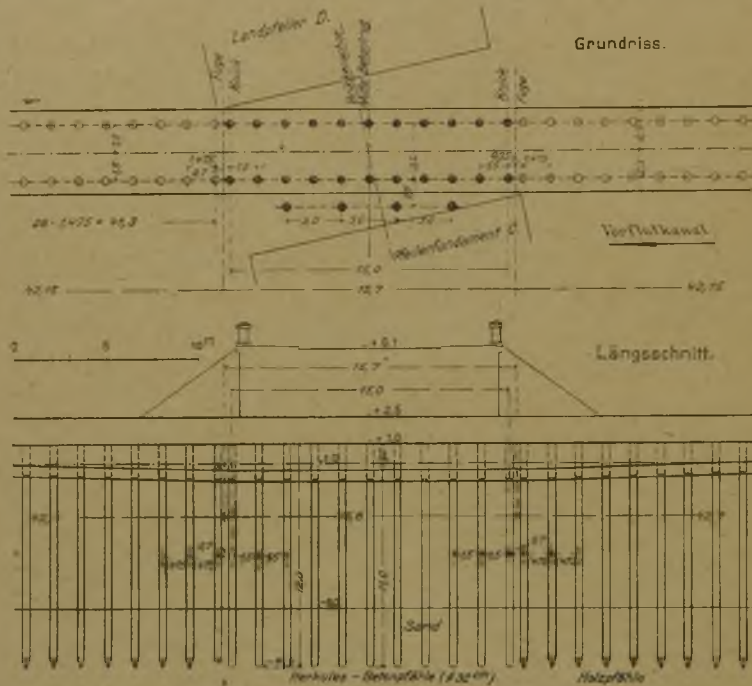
und b. Schnitt und Grundriß unter der Straßenbrücke.
